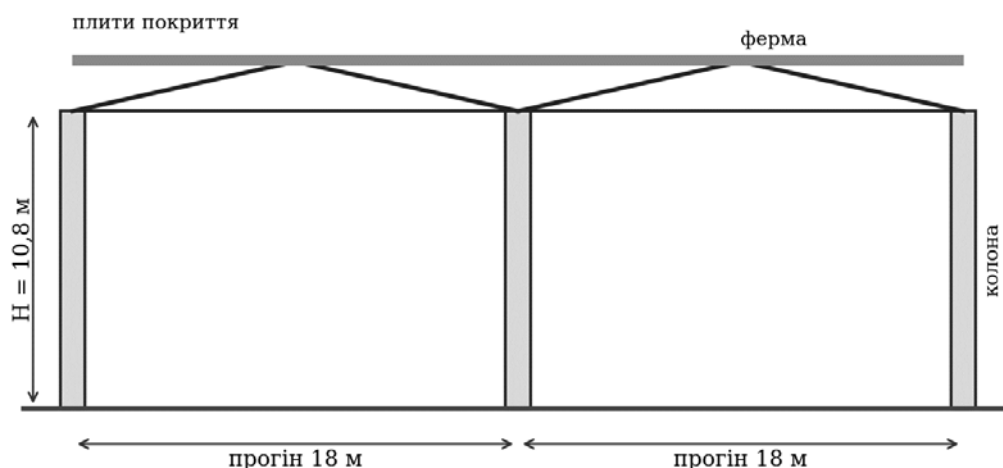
Поперечна конструктивна схема будівлі
